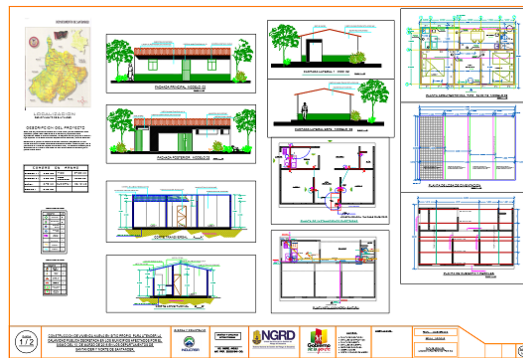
Plano Arquitectónico tipo 2 Fuente: CONTINUAR S.A.S.
